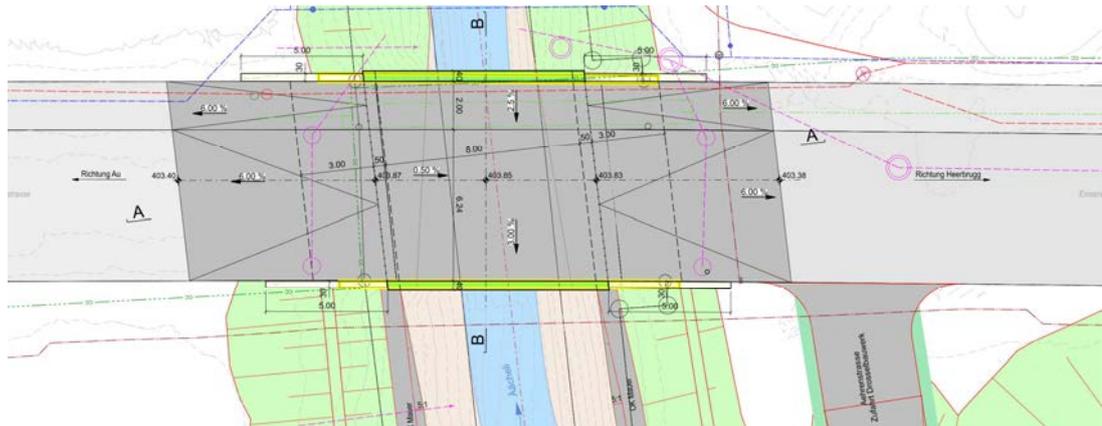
Horizontale Linienführung der Brücke Emserenstrasse, Ächeli
